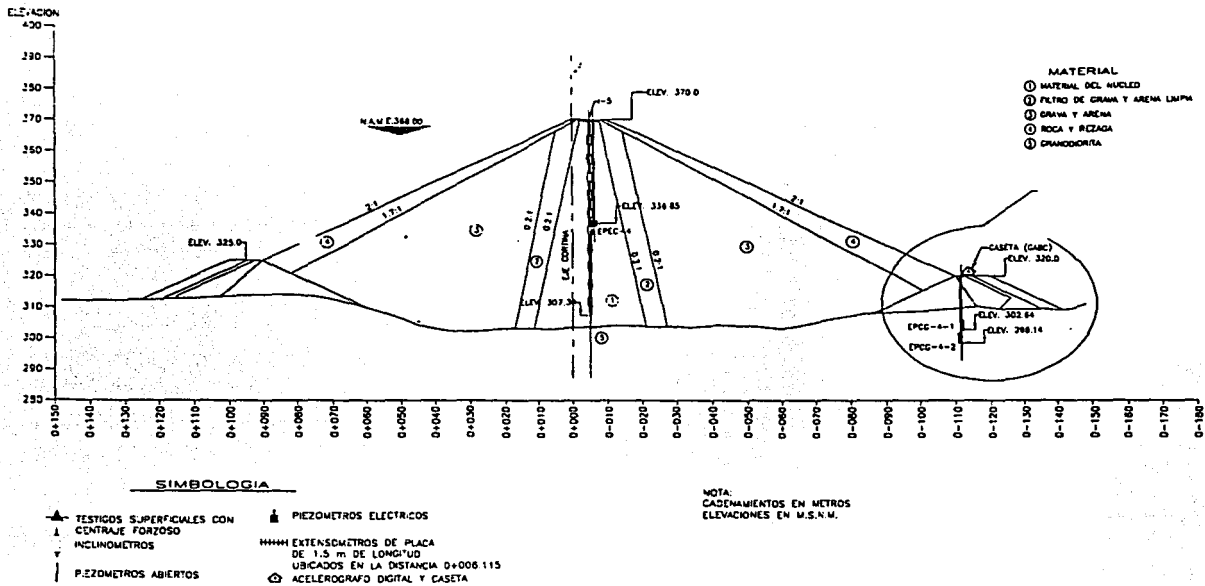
Instrumentación. Sección transversal cadenamiento 0+205.
